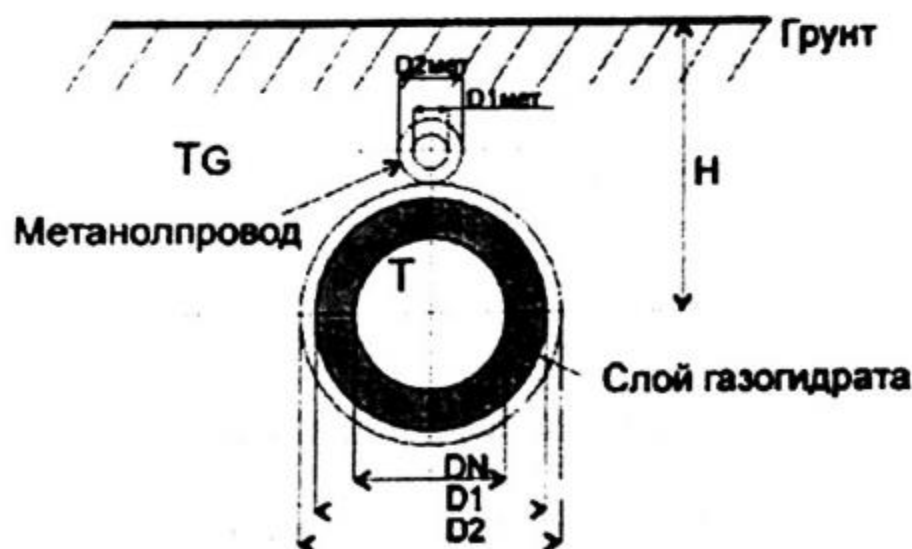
Подземная прокладка трубопровода без теплоизоляции
